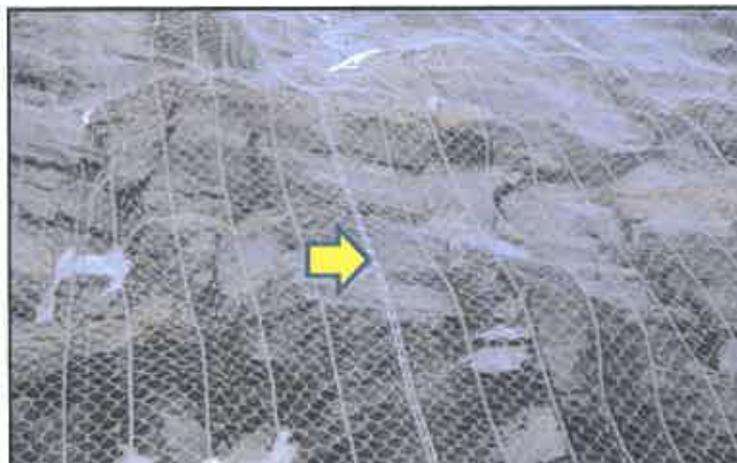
Exemplo de aplicação de rede metálica de tripla torção e da união entre painéis adjacentes
